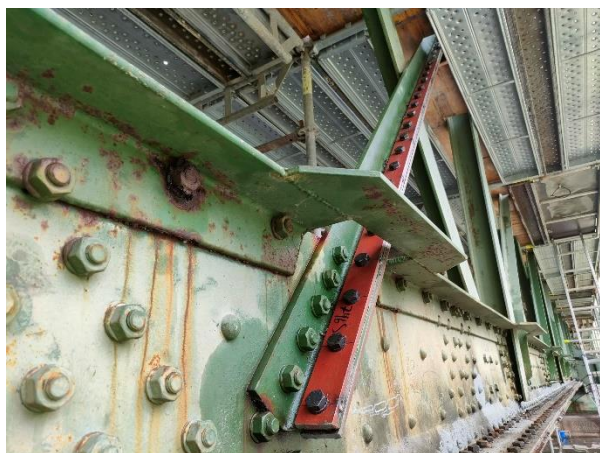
Refuerzo con chapa metálica atornillada en diagonal de celosía exterior
